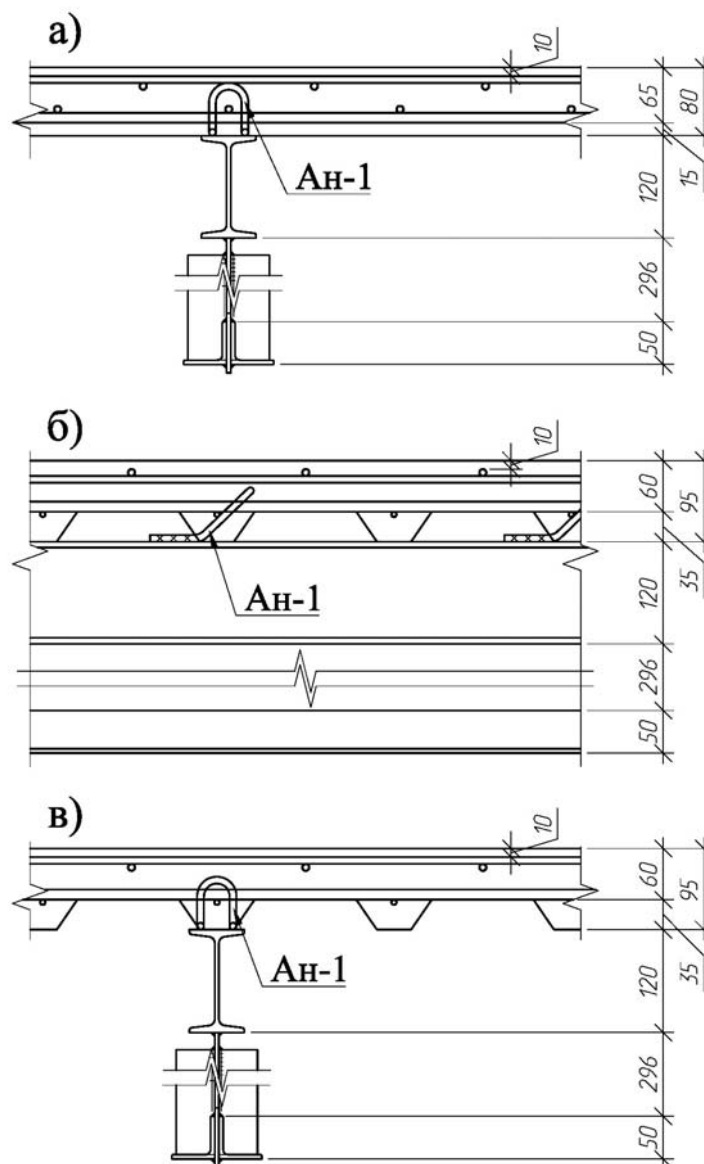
Три типи дослідних зразків плити: а) бетонування по плоскій щитовій опалубці; б) бетонування по профільованому настилі ребрами поперек шпренгельних конструкцій; в) бетонування по профільованому настилі ребрами вздовж шпренгельних конструкцій; АН-1 – гнучкий анкер.
